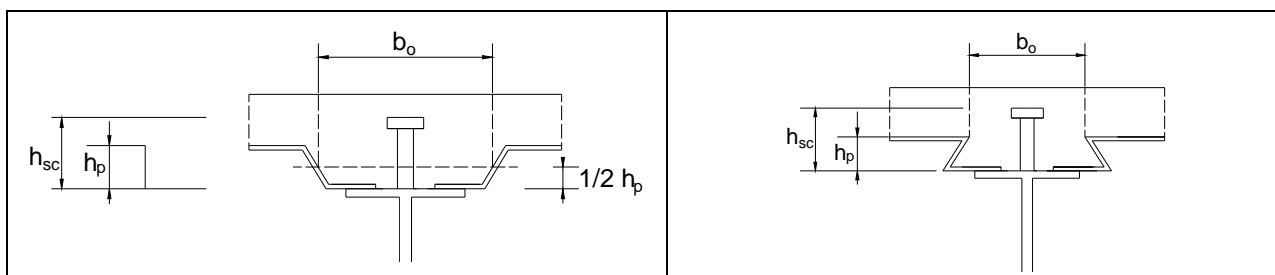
(a) *Disposizione della lamiera grecata rispetto al profilo in acciaio.
